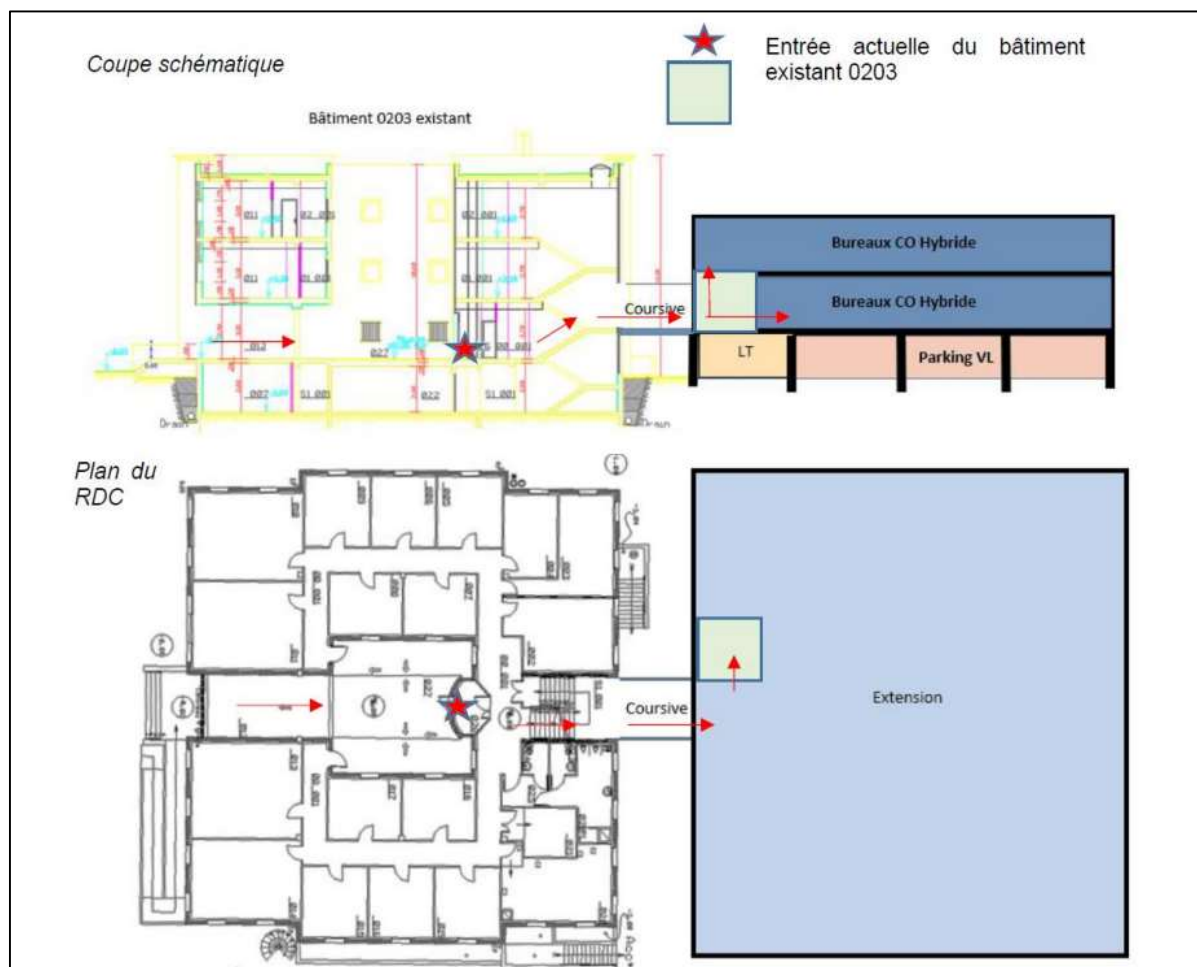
Plan RDC et coupe schématique du projet d'extension du bâtiment 0203.
